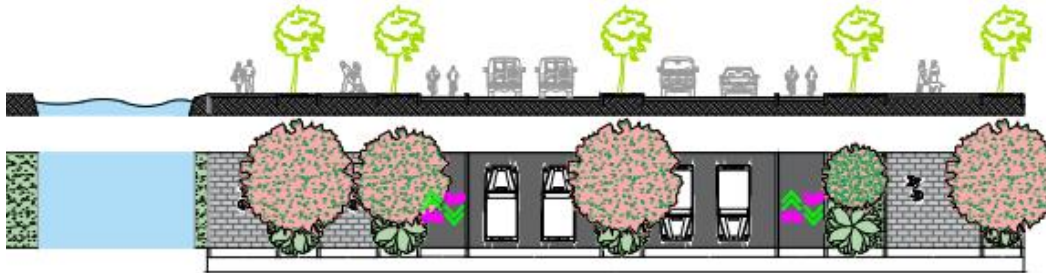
Perfil de Propuesta para la Avenida Daniel Octavio Camejo
